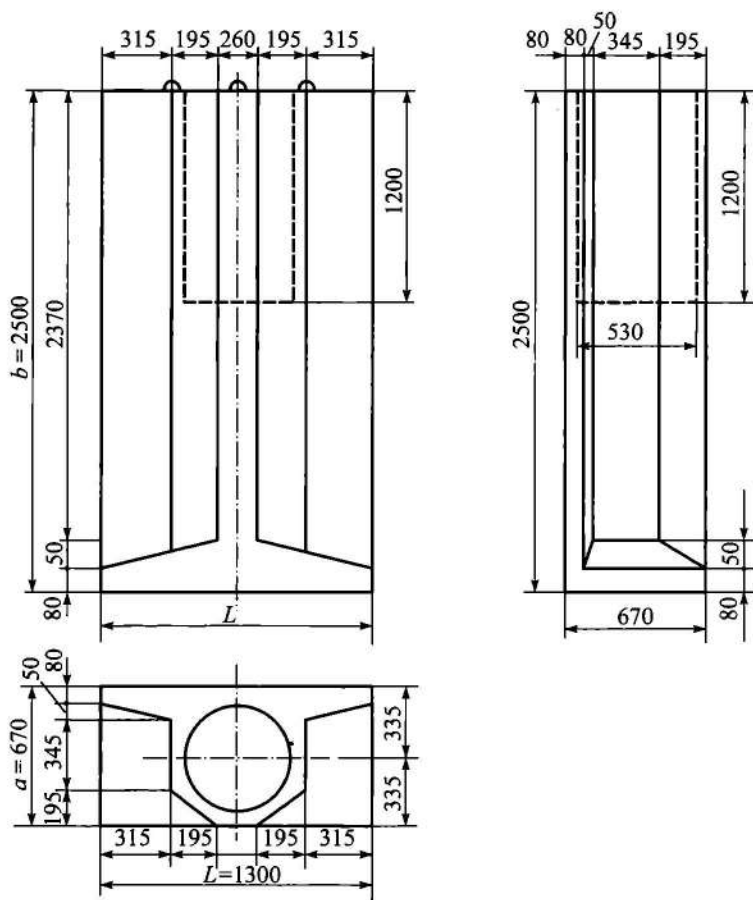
Блочный фундамент типа ЗФ-1
